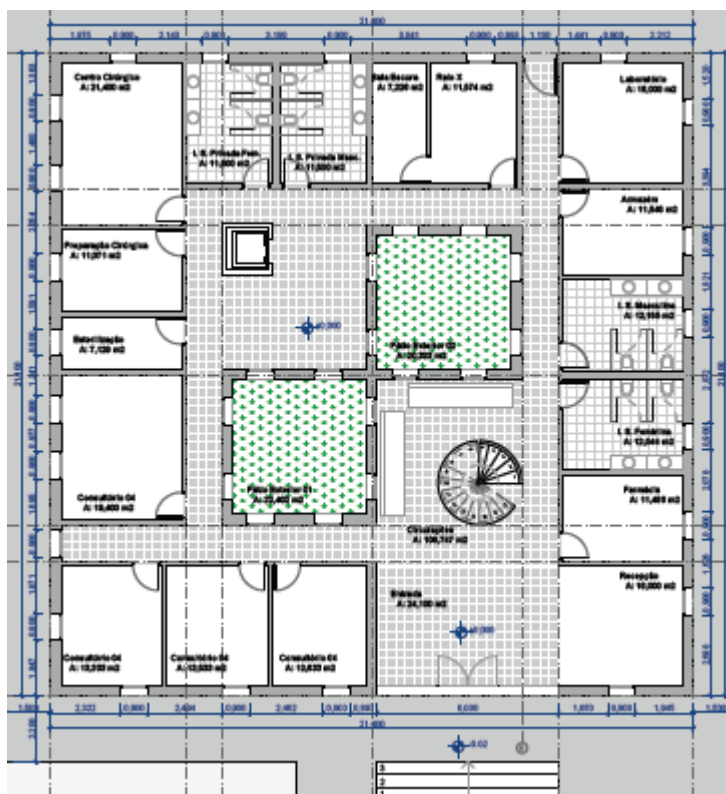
Planta do Piso 0 (Fonte: Projecto de Arquitectura)
